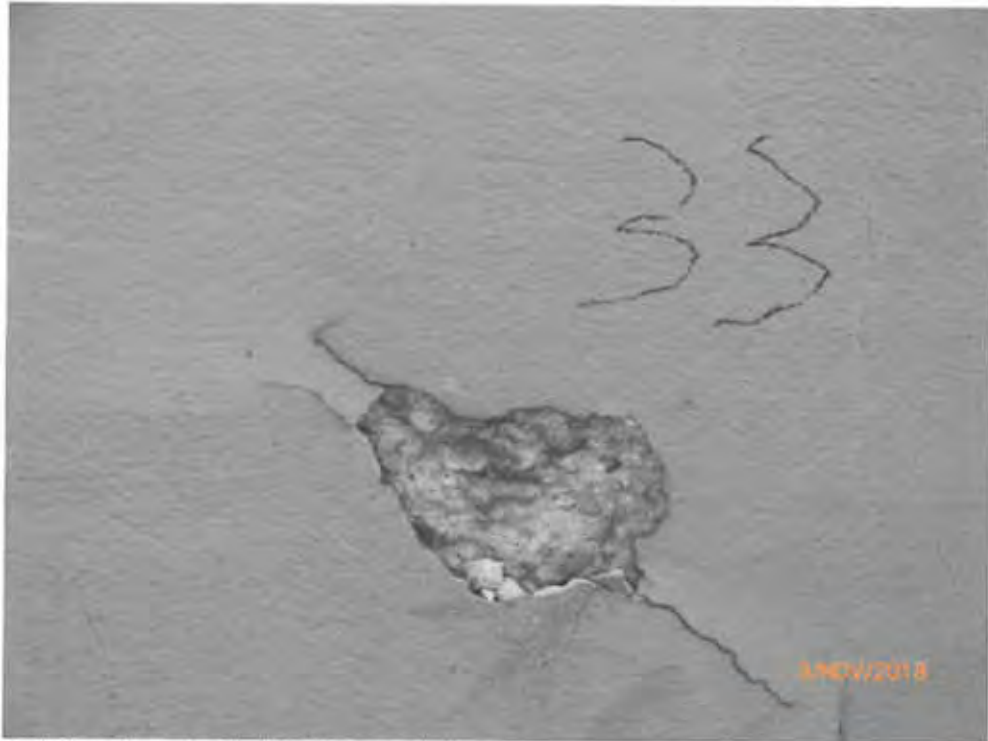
Achse A, Block 34: Betonabplatzungen, Bewehrungskorrosion
